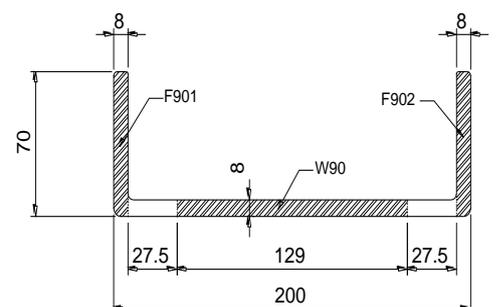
引抜直角方向の試験体採取位置 (単位: mm)
